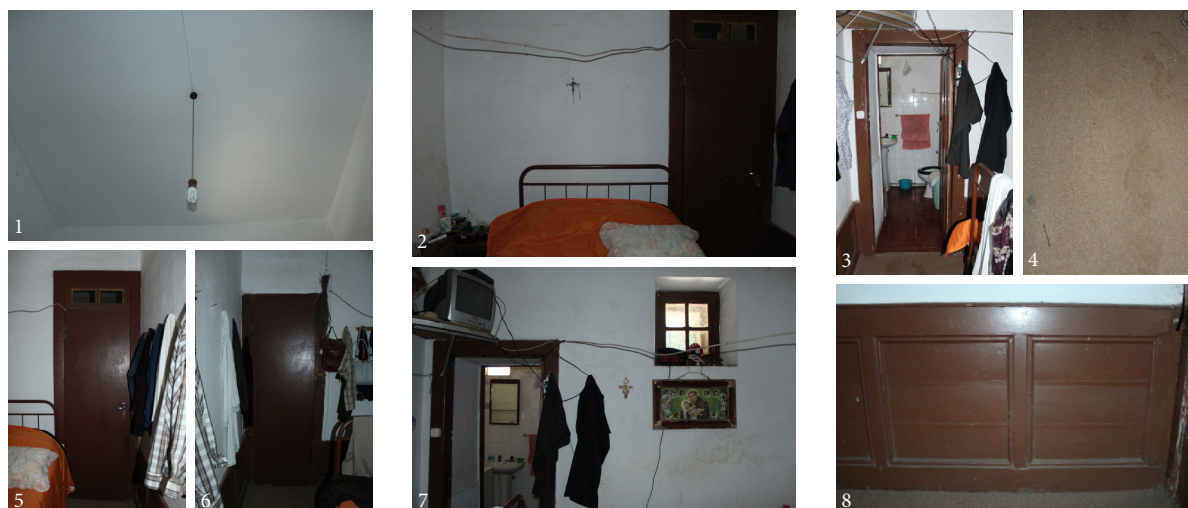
Fotos do Quarto 5. 1) Teto; 2) Vista do Quarto; 3) Acesso à Casa de Banho Privativa; 4) Pavimento; 5) Porta de Acesso ao quarto 4; 6) Acesso ao Corredor de Serviço; 7) Vista de parede exterior; 8) Lambril
